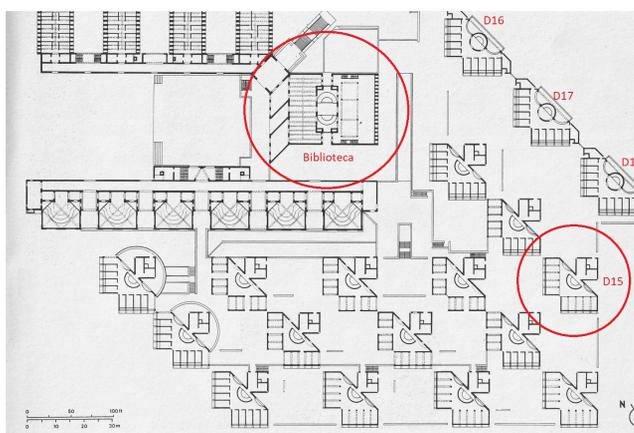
Plano general del IIMA. Se señalan las zonas de intervención de la restauración: La biblioteca Vikram Sarabhai y el dormitorio D15. La entrada al campus está arriba, al noreste, presentando los dormitorios 16, 17 y 18.
